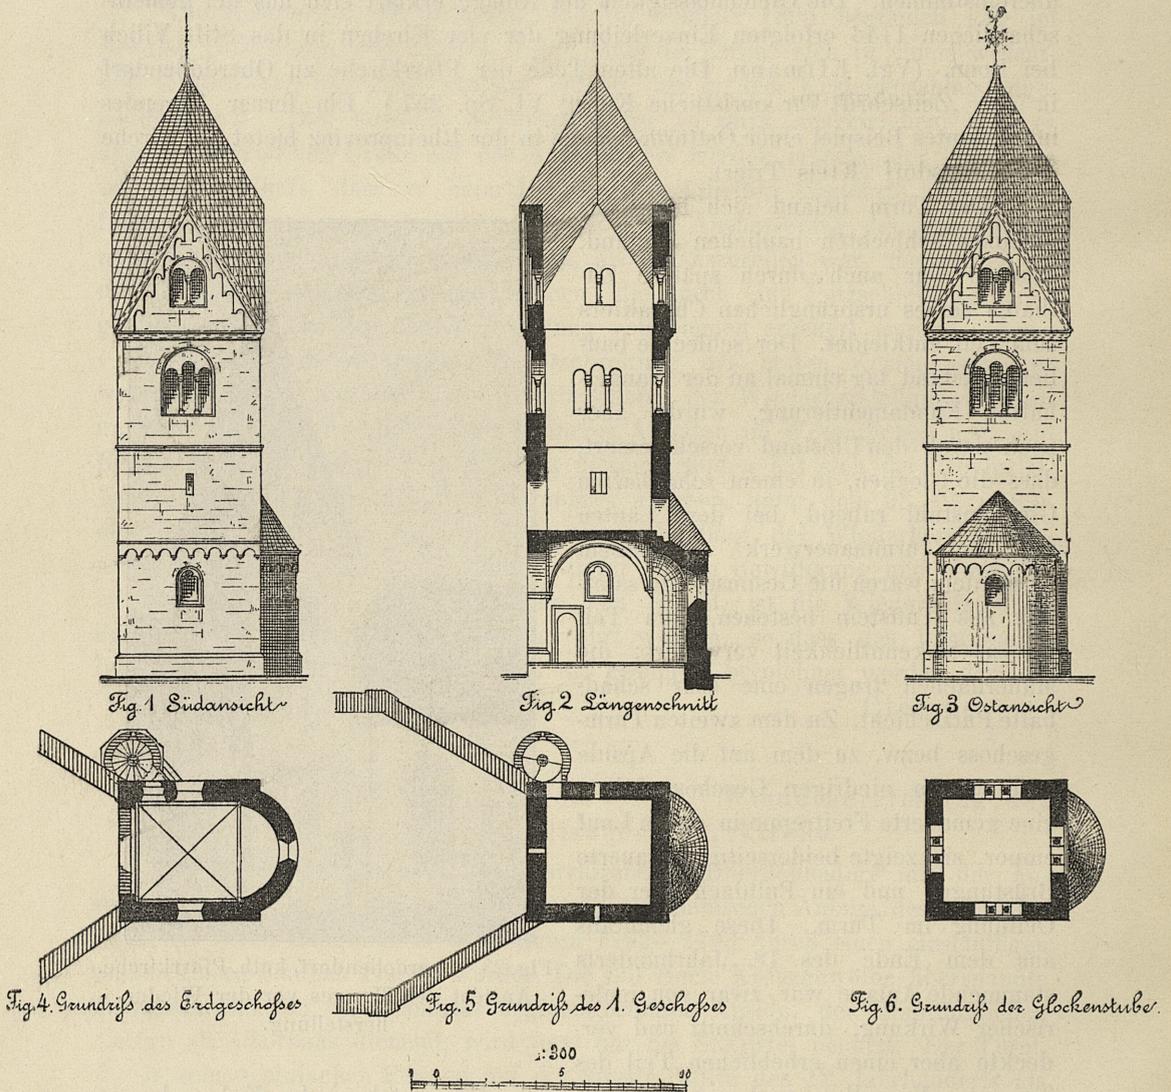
Oberdollendorf, kathol. Pfarrkirche. Grundrisse, Aufrisse und Schnitte des Turmes nach der Wiederherstellung.
